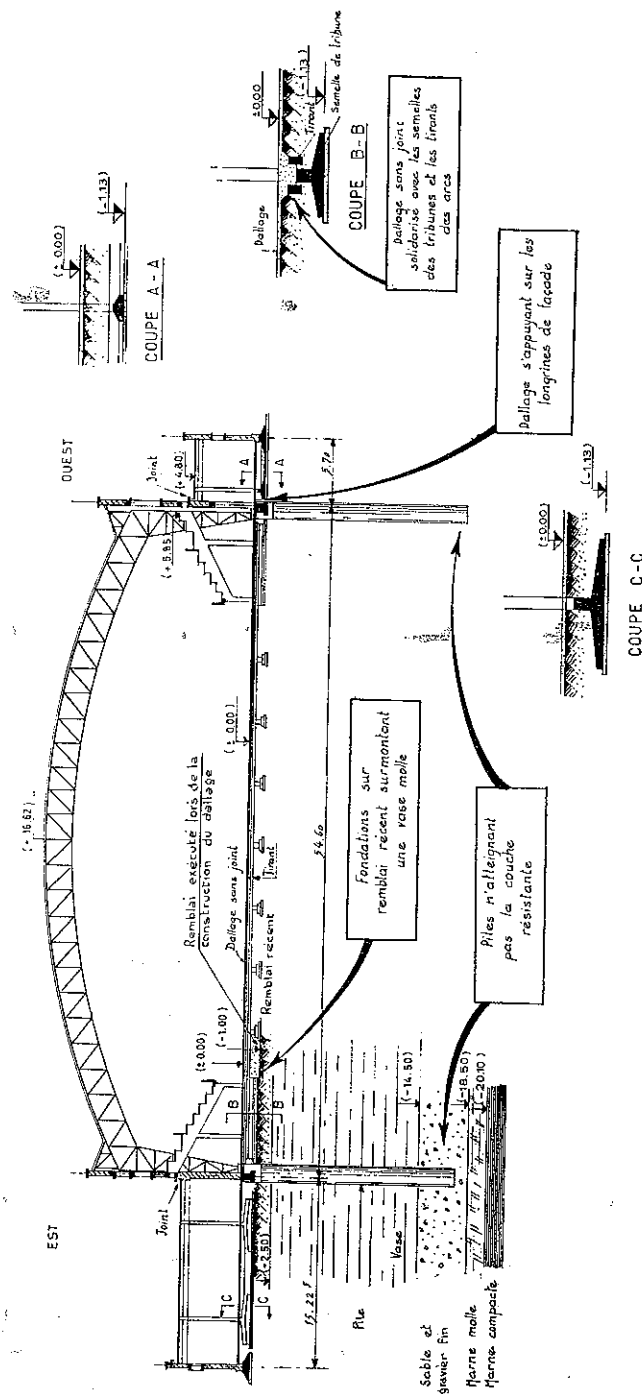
Dislocation d'un bâtiment construit sur des couches compressibles.
